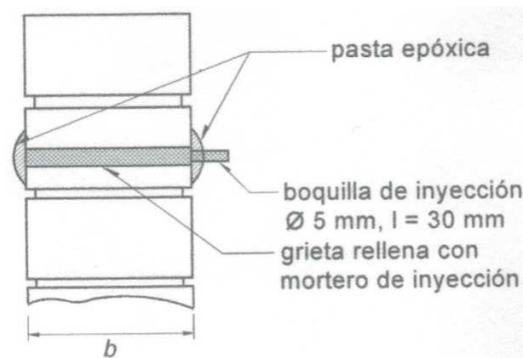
Reparación de grietas en estructuras de mampostería mediante inyección.
